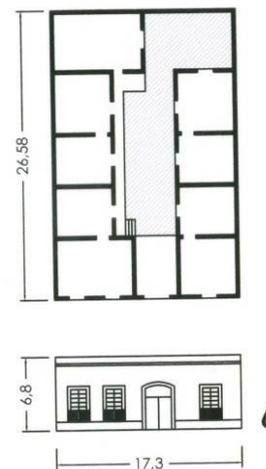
CASA VECINDAD CON PORTÓN Y TRES VENTANAS AL FRENTE; 5 METROS DE ANCHO DEL PATIO CENTRAL
